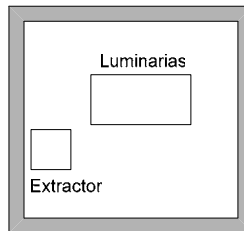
Vista de planta de ubicación de luminarias y extracción de aire.
